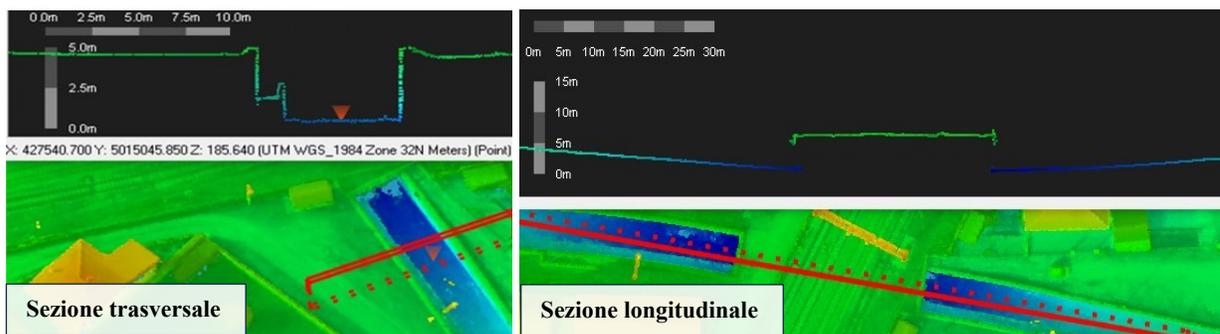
Sezione trasversale e longitudinale del sottopasso.
